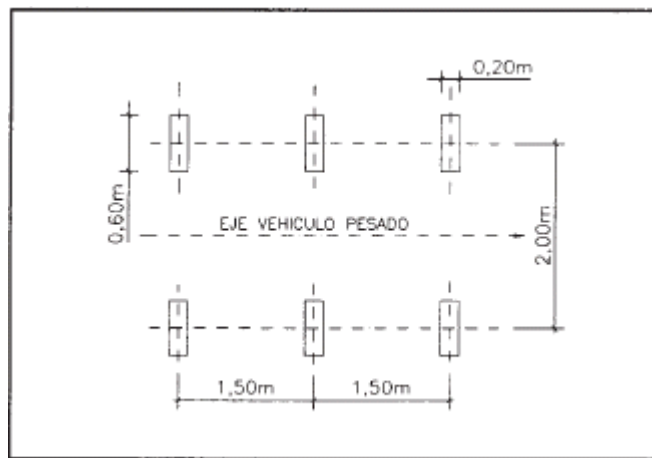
Planta del tren de cargas de la Instrucción IAP-98
